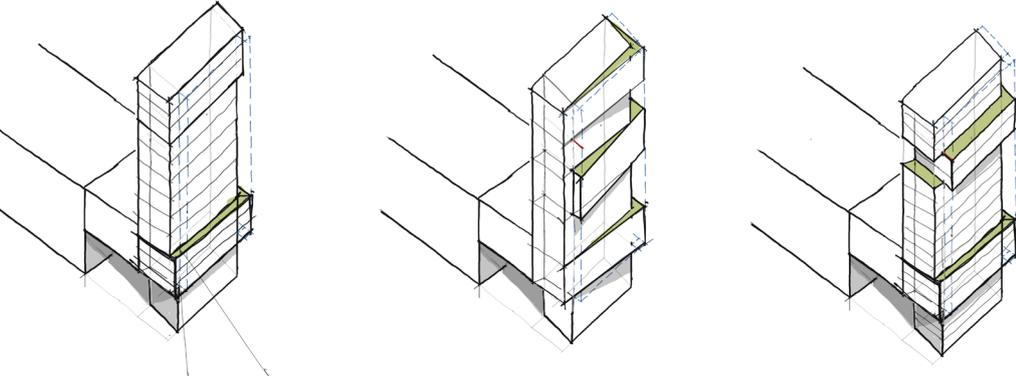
Beispielhafte Baukörpervarianten Campus-Tower
